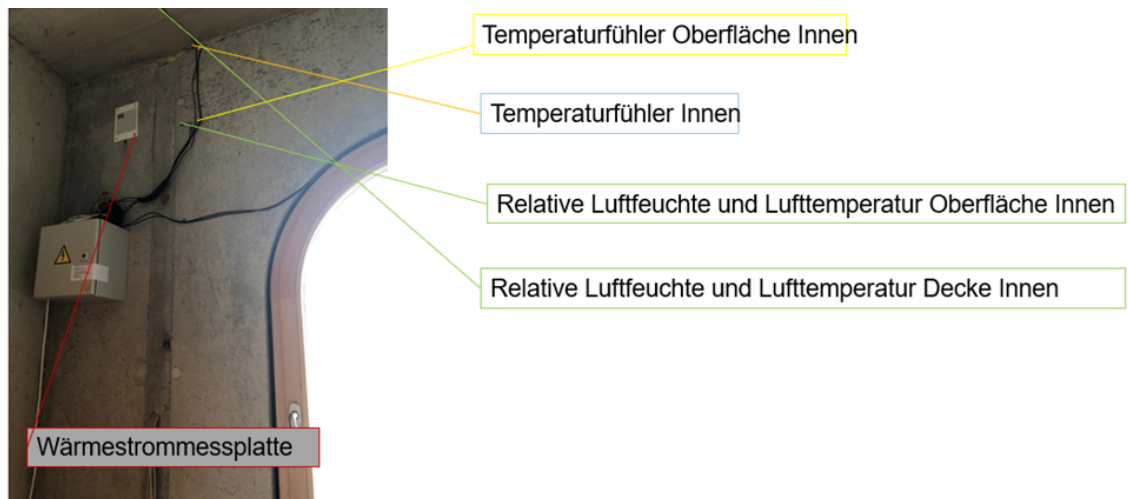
Aufbau Messtechnik Westseite Leichtbetongebäude
